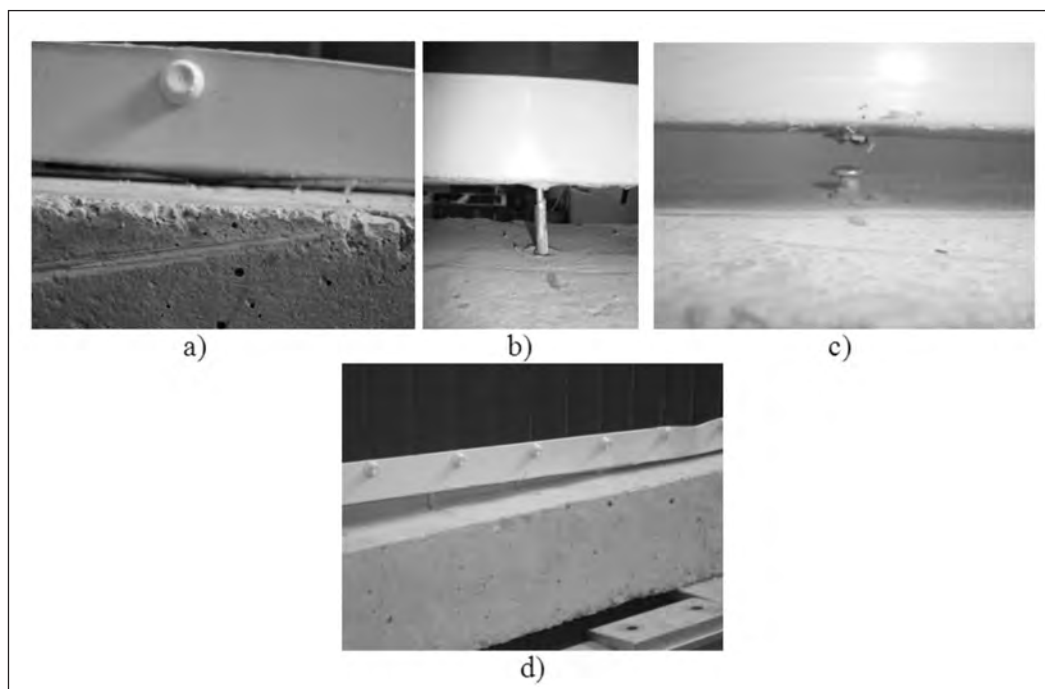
Detalles de la falla del muro con anclajes cada 290 mm: a) Levantamiento del remate para derivas de 0,5%. b) Extracción de un anclaje. c) Desgarramiento de la lámina inferior del remate. d) Levantamiento total del remate con el muro.
